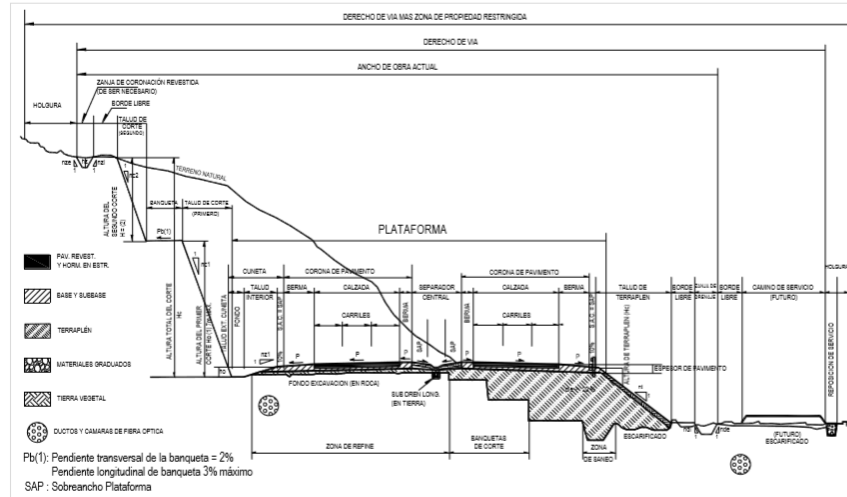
Sección transversal tipo a media ladera para una autopista en tangente
